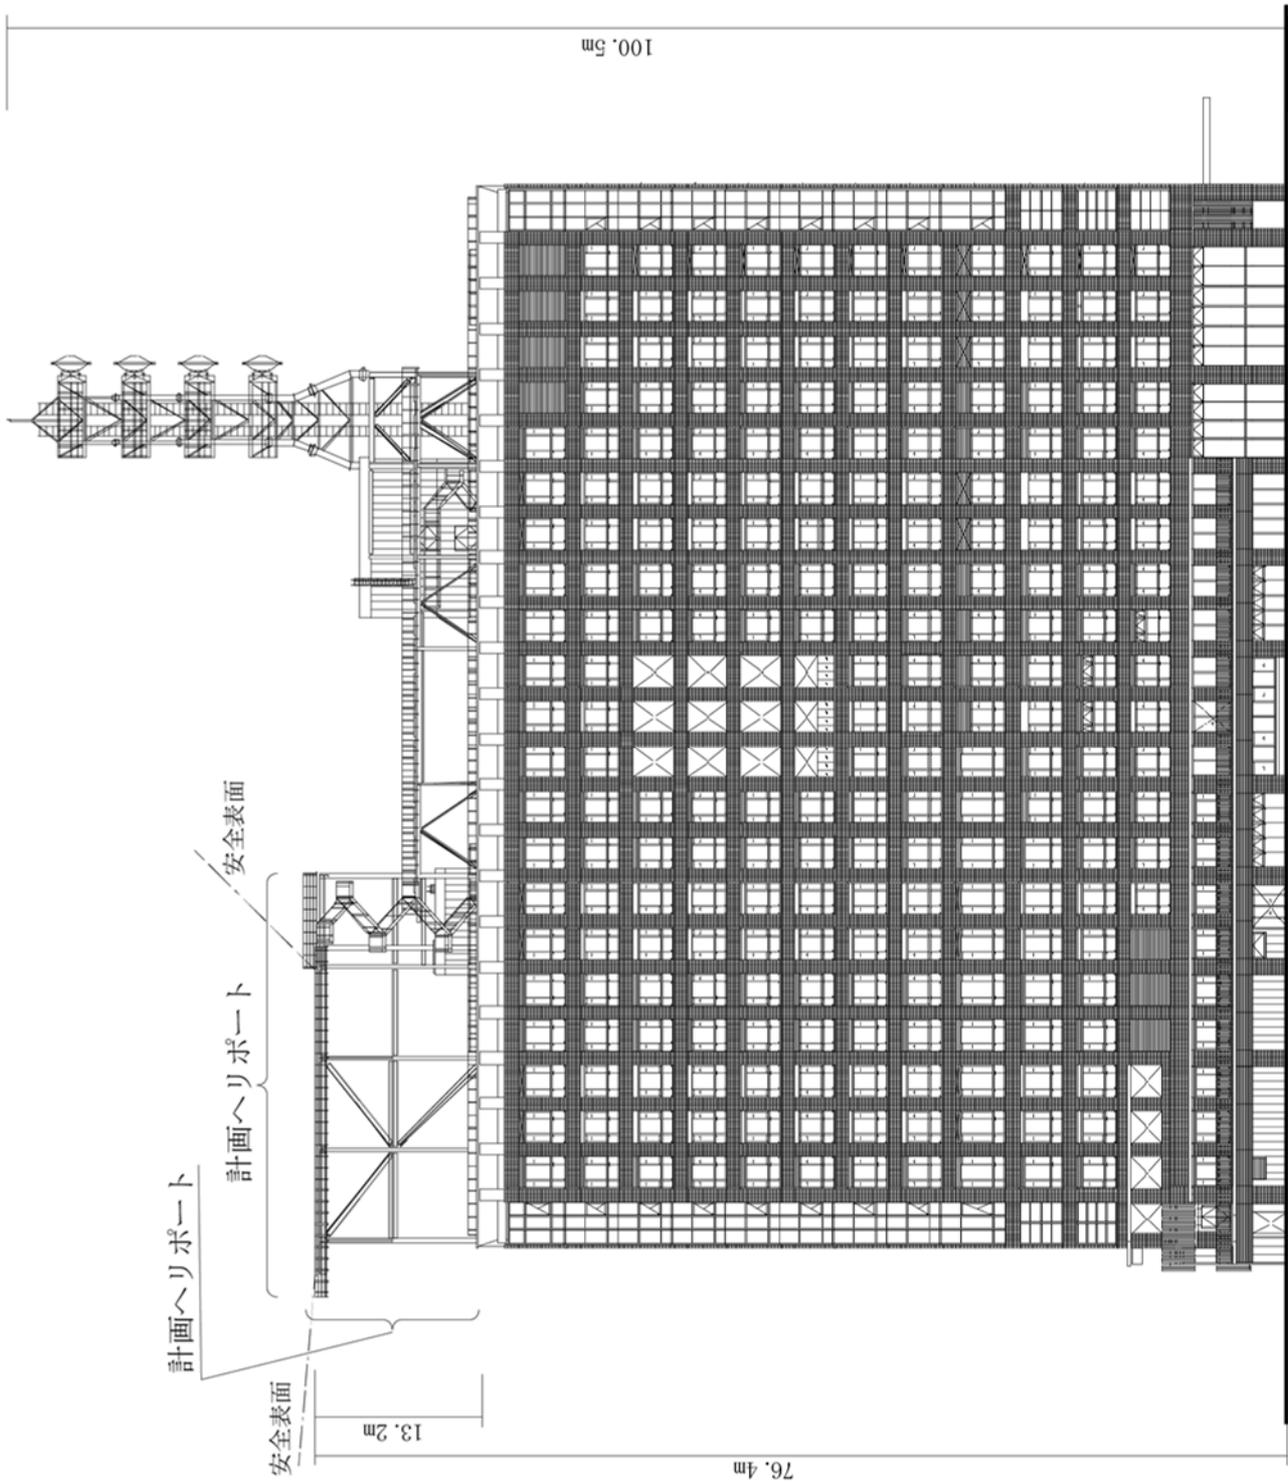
計画ヘリポート設置建築物の西側立面図
